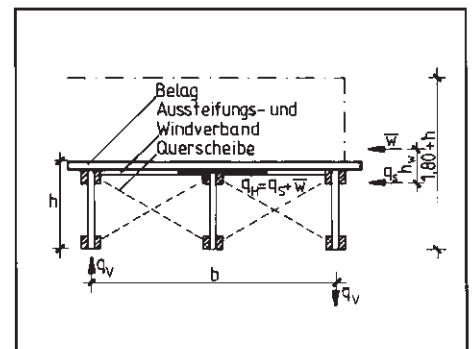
Angreifende Belastung für Aussteifungs- und Windverband bei mit Verkehrslast belasteter Fußgängerbrücke mit Fachwerkträgern und obenliegender Verkehrsbahn
